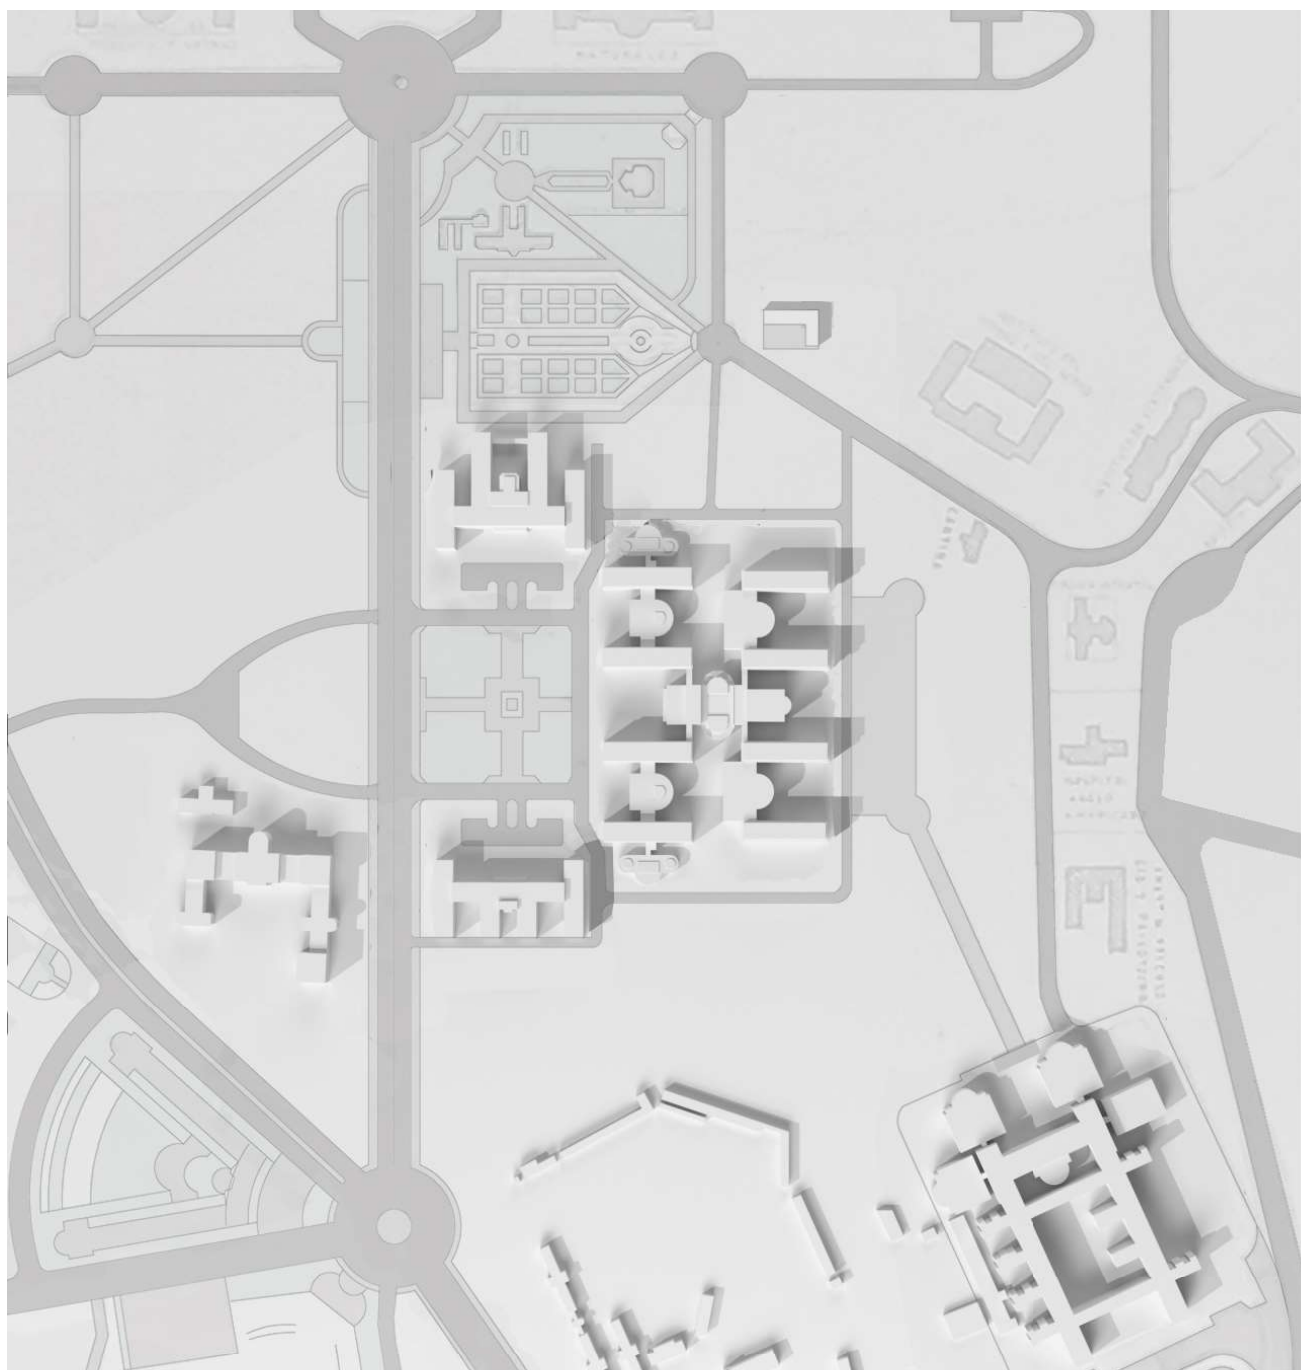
Planta del conjunto del campus médico. Propuesta final.
